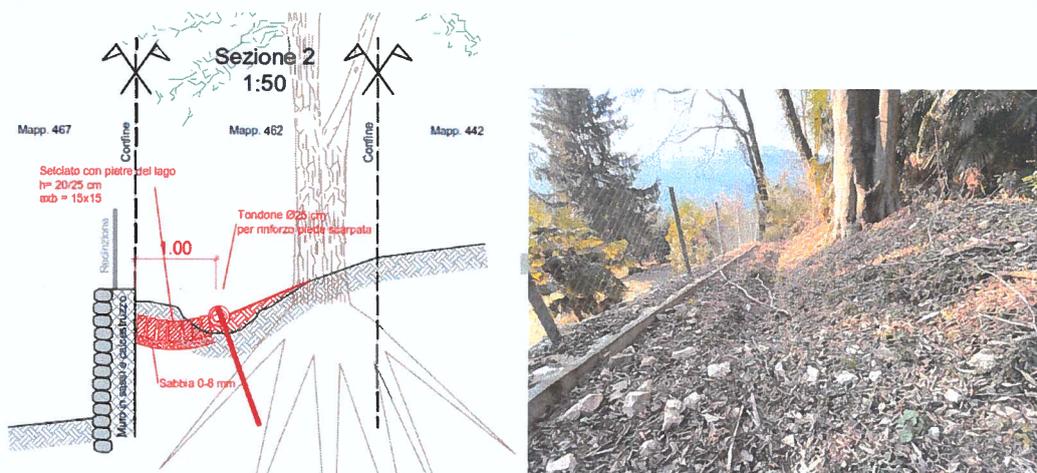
Estratto piano 030 sezione 2 e fotografia situazione esistente sezione 2.
